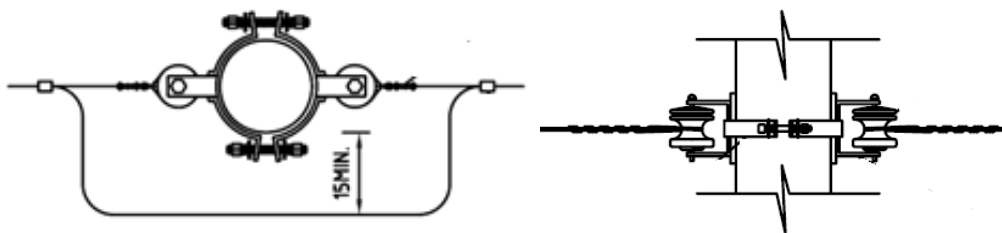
Armado del porta neutro en estructuras EST-3SD
